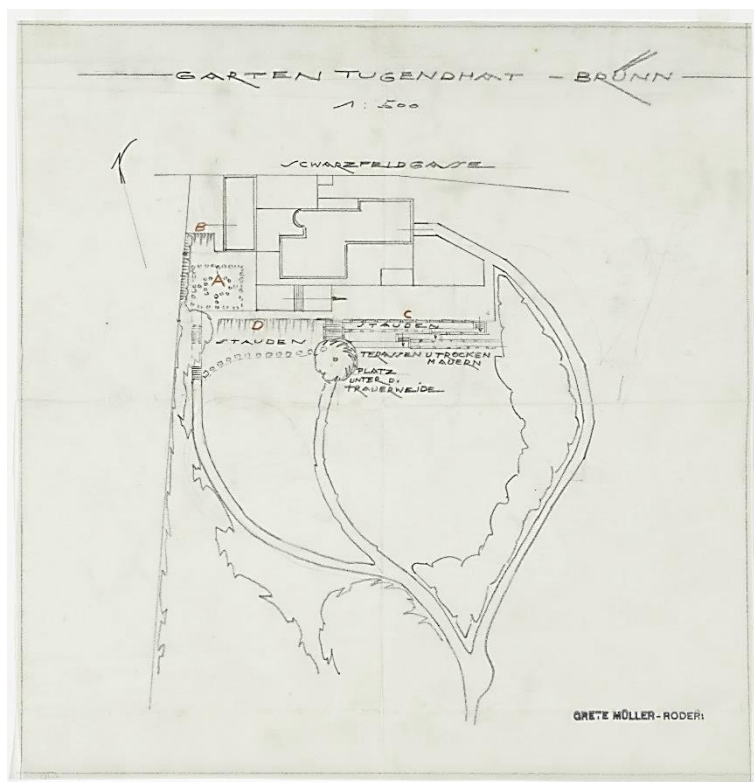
Planta de implantação da Casa Tugendhat, 1928-1930.
